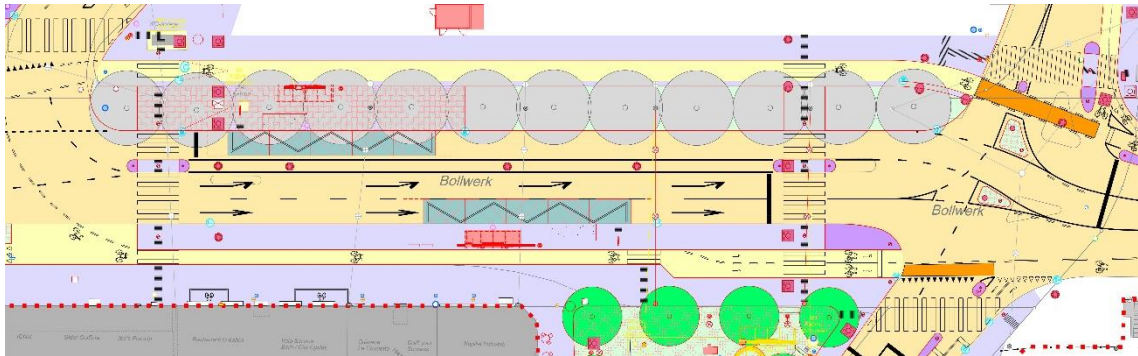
Strassenlayout Haltestelle Bollwerk
